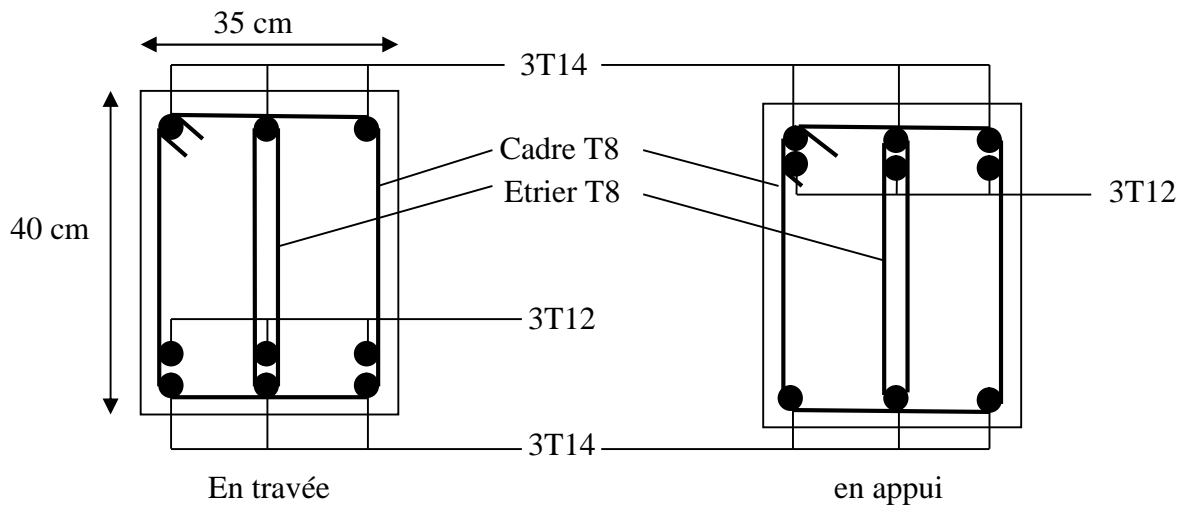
Schéma de ferrailage de la poutre principale RDC
